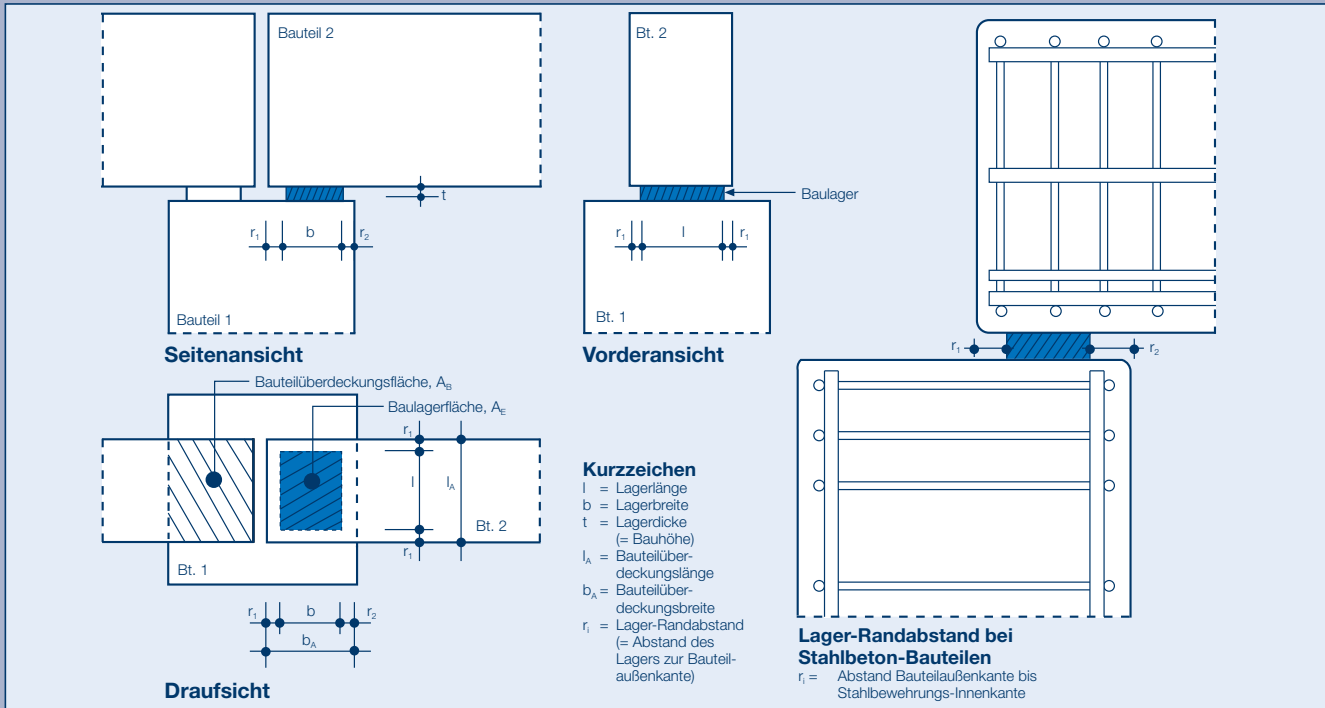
Maximale Größe der Grundrissfläche eines Elastomers unter Berücksichtigung der Randabstände nach Heft 600, Deutscher Ausschuss für Stahlbetonbau. Im Stahlbau sollte der Randabstand zur Bauteilaußenkante mindestens 10 mm betragen.
